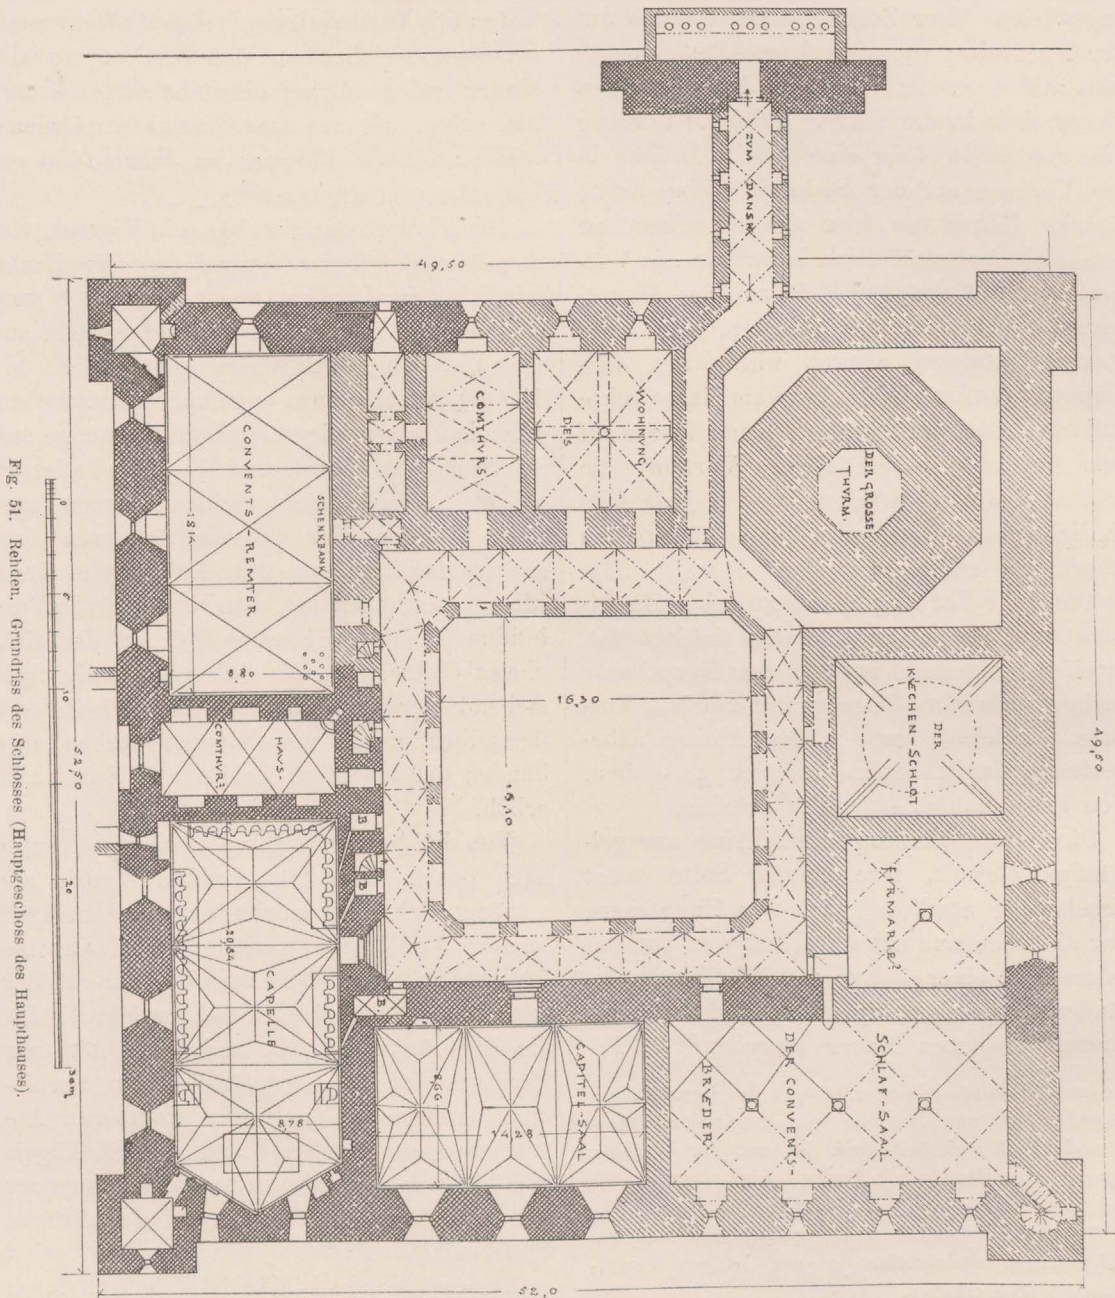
Rehdau. Grundriss des Schlosses (Hauptgeschoss des Haupthauses).
